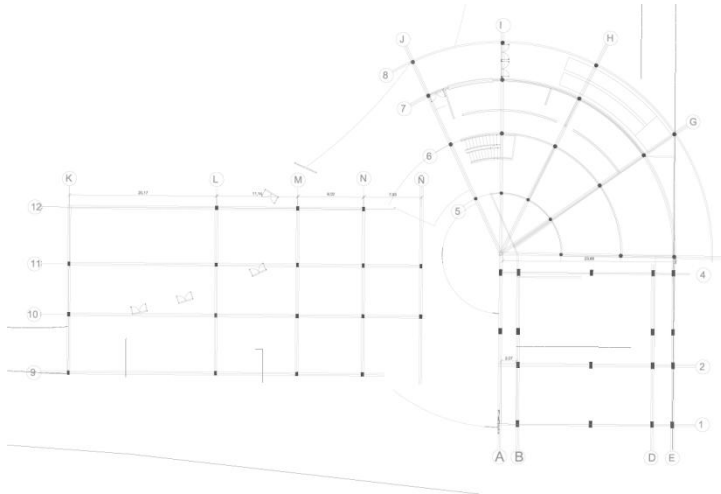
Cimentación Zapatas Aisladas con Vigas de Amarre
